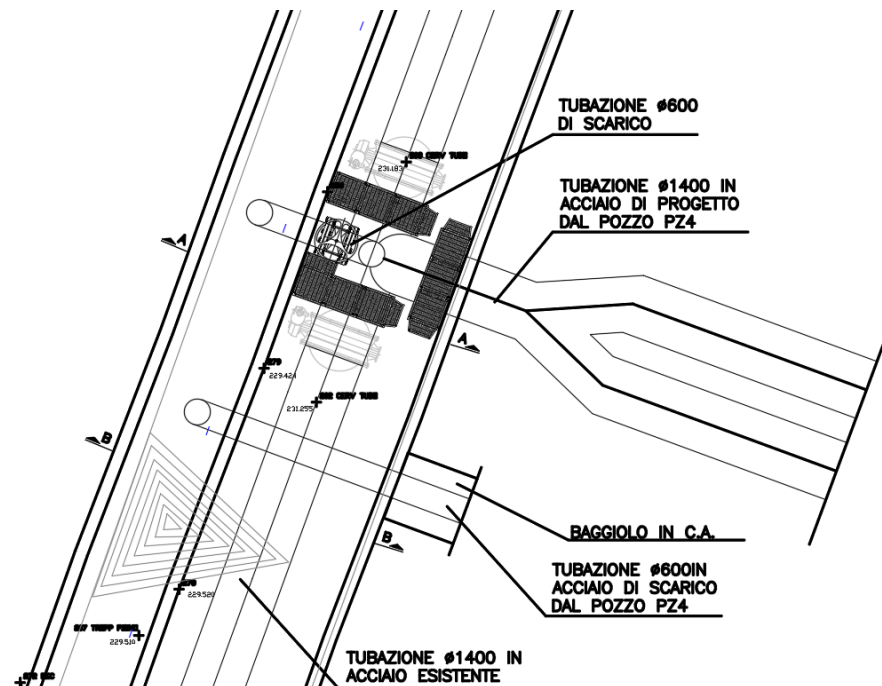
Rappresentazione in pianta del manufatto M2
